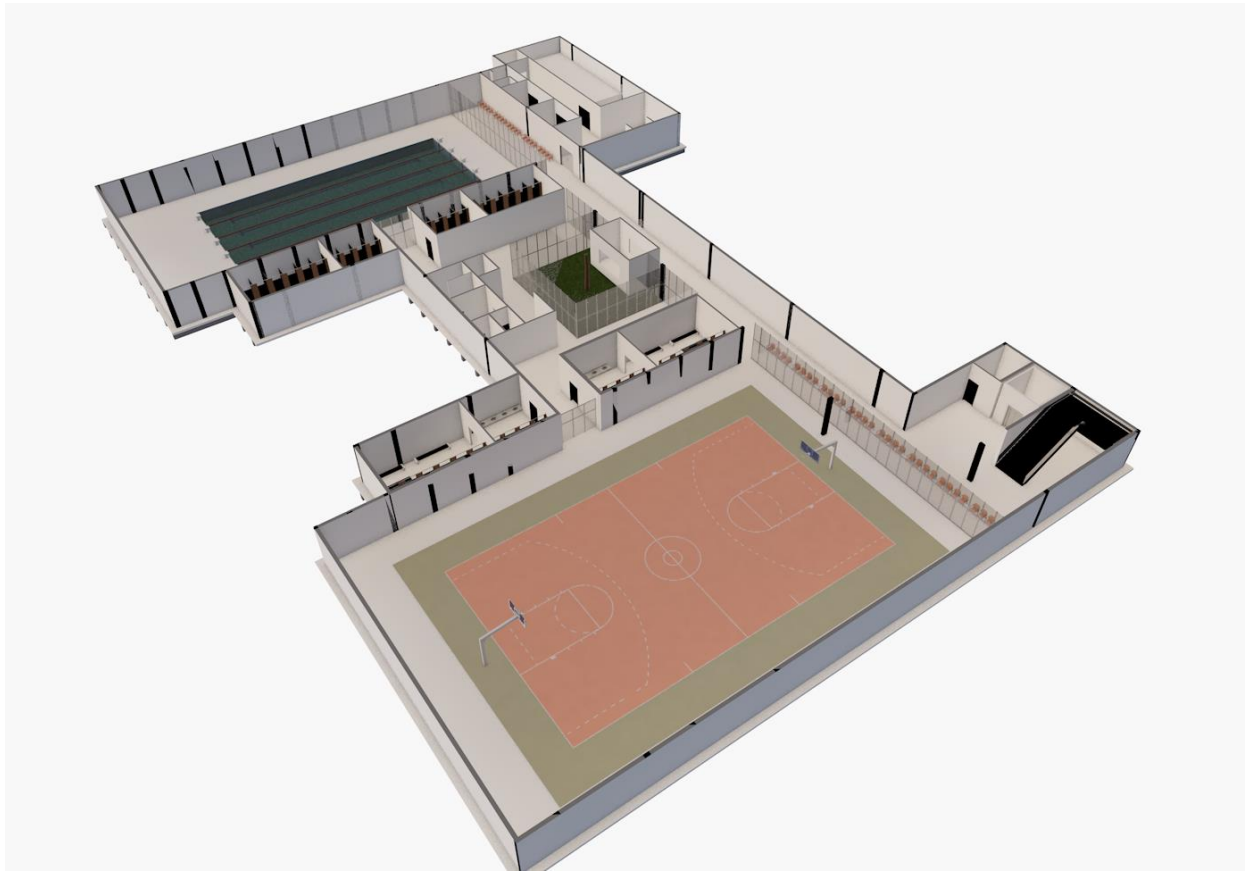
Corte de planta de sótano en perspectiva. Fuente, elaboración propia
